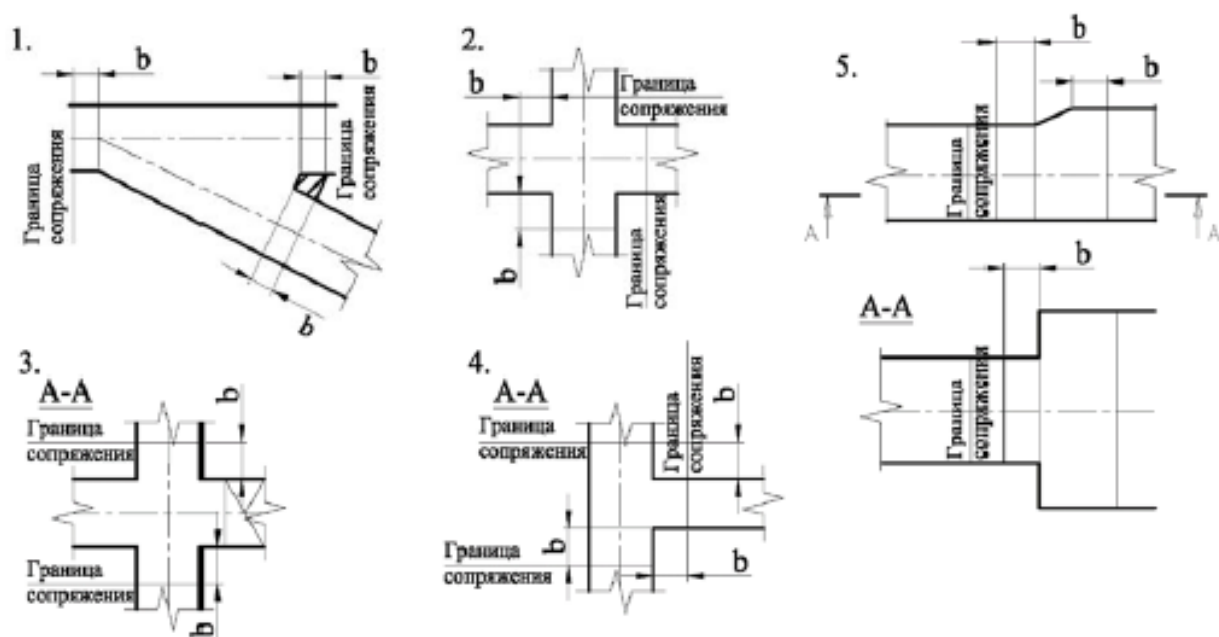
Основные типы сопряжений, используемые на рудниках КФ АО «Апатит»: 1 - остроугольное ответвление откаточной выработки; 2 - пересекающиеся под прямым углом горизонтальные выработки; 3 - горизонтальная и вертикальная выработки; 4 - горизонтальная и наклонная выработки; 5 - разновысотные выработки; b - ширина большей из сопрягаемых выработок
